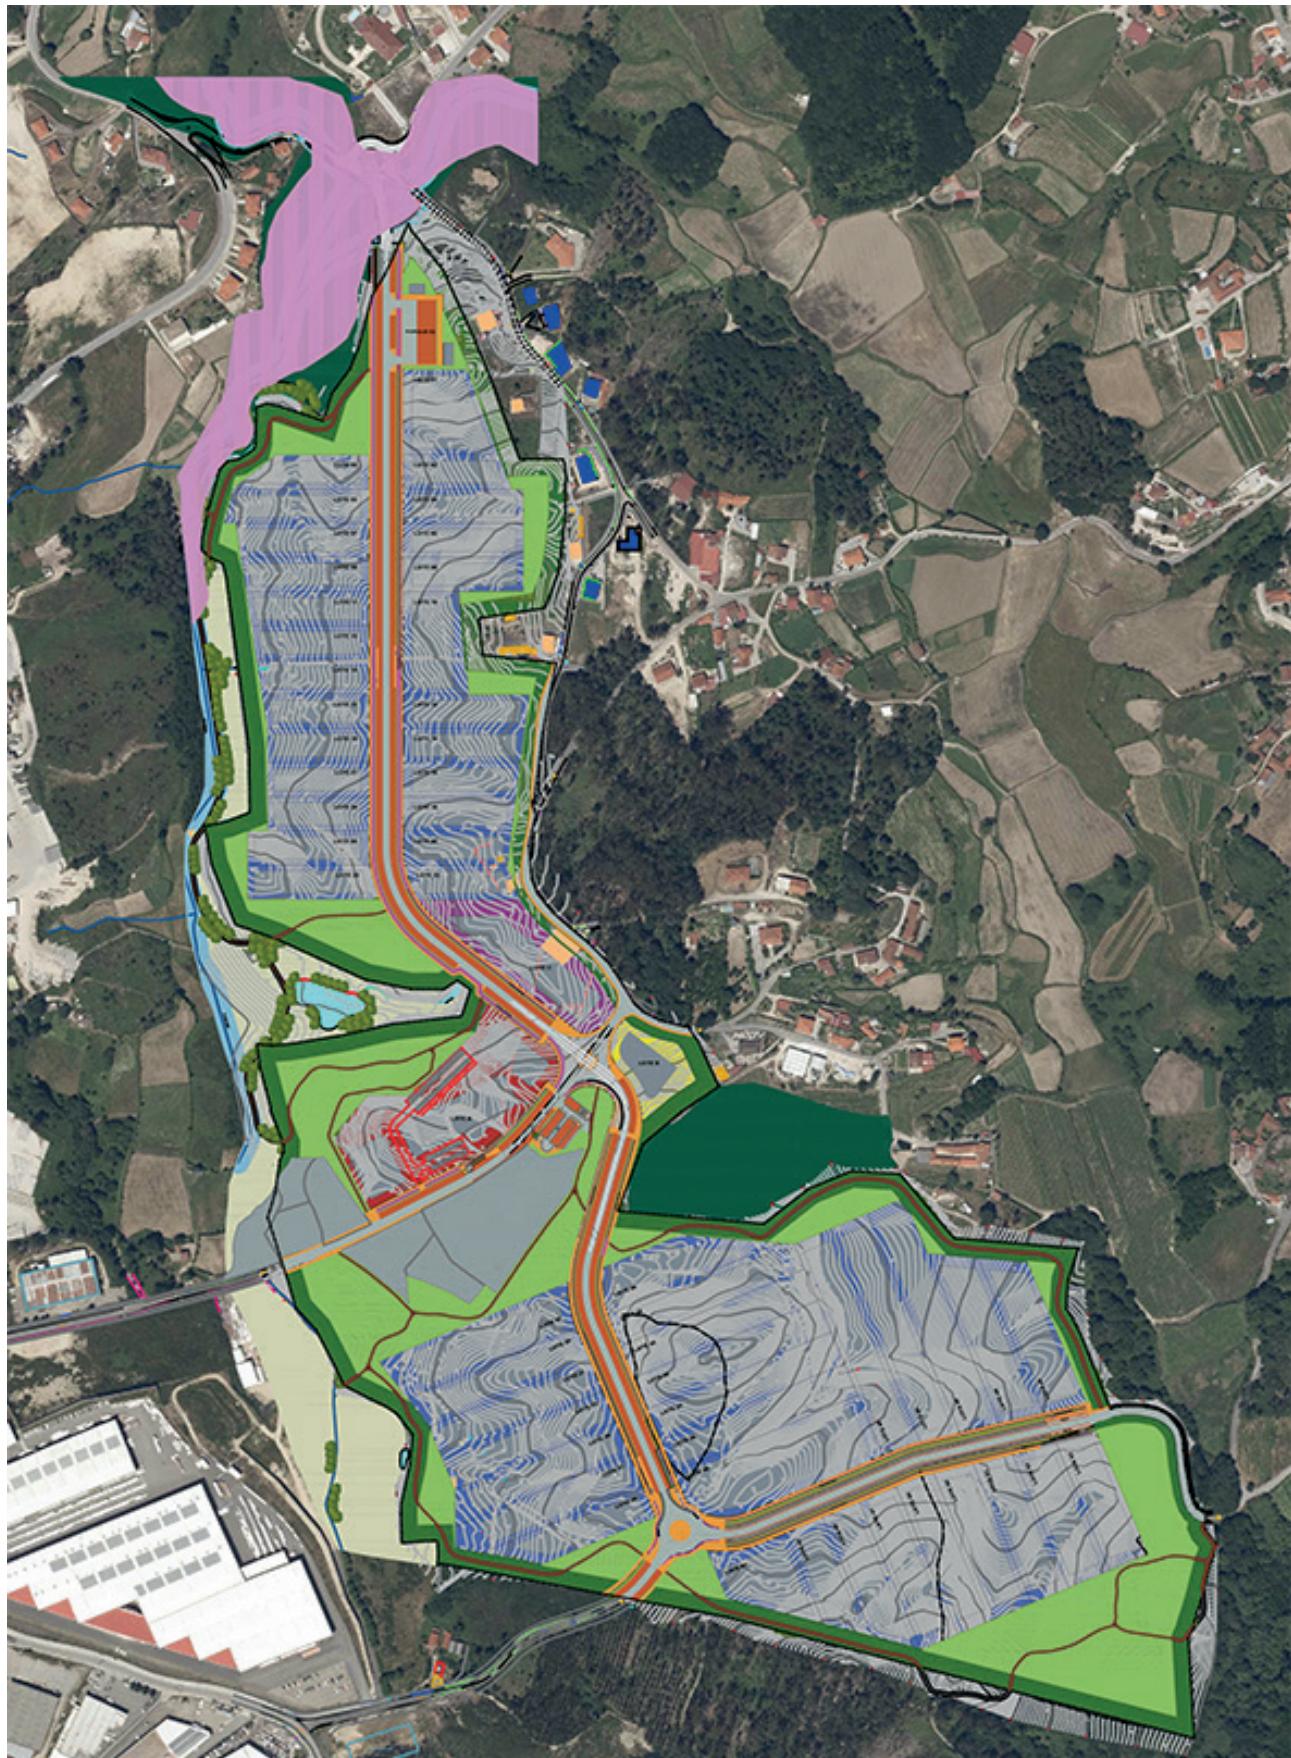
Planta de Implantação da Área de Acolhimento Empresarial de Regadas
